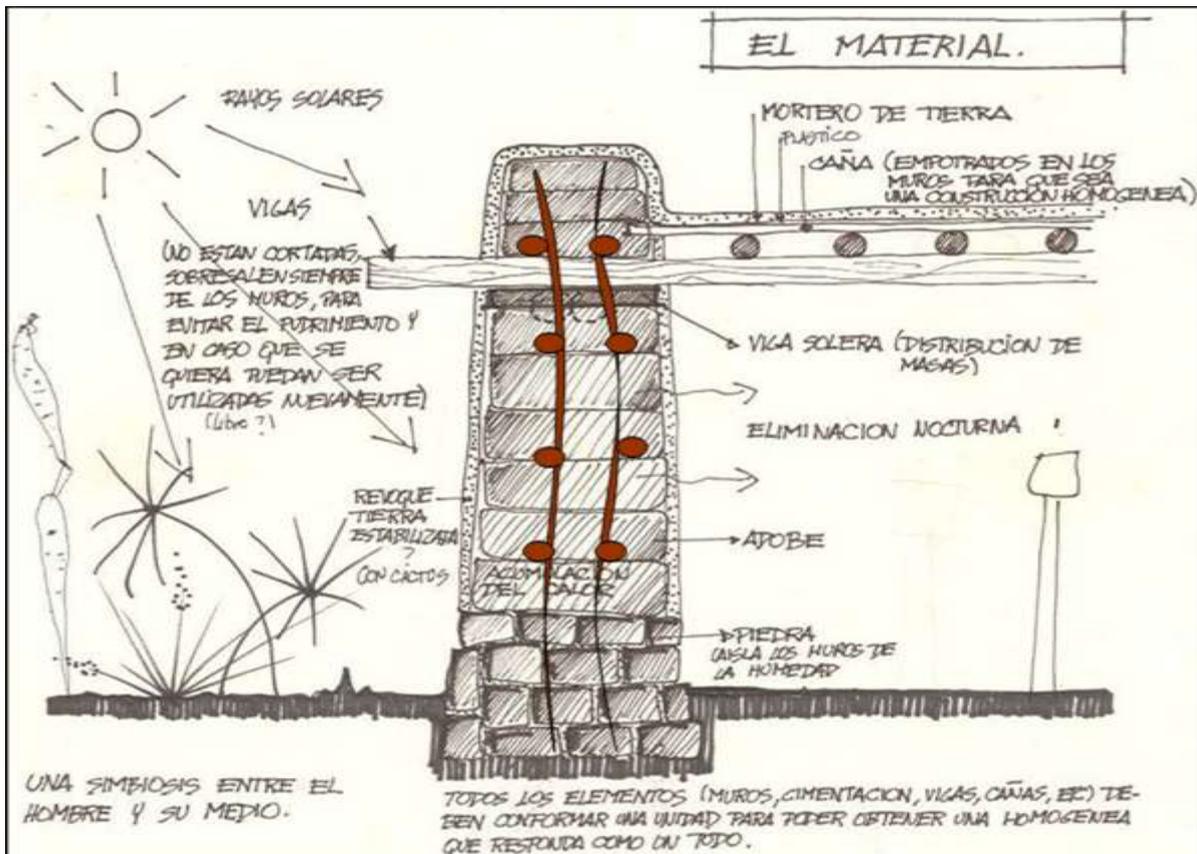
Corte esquemático de muro y cubierta sismo-resistente, construcción con tierra.
